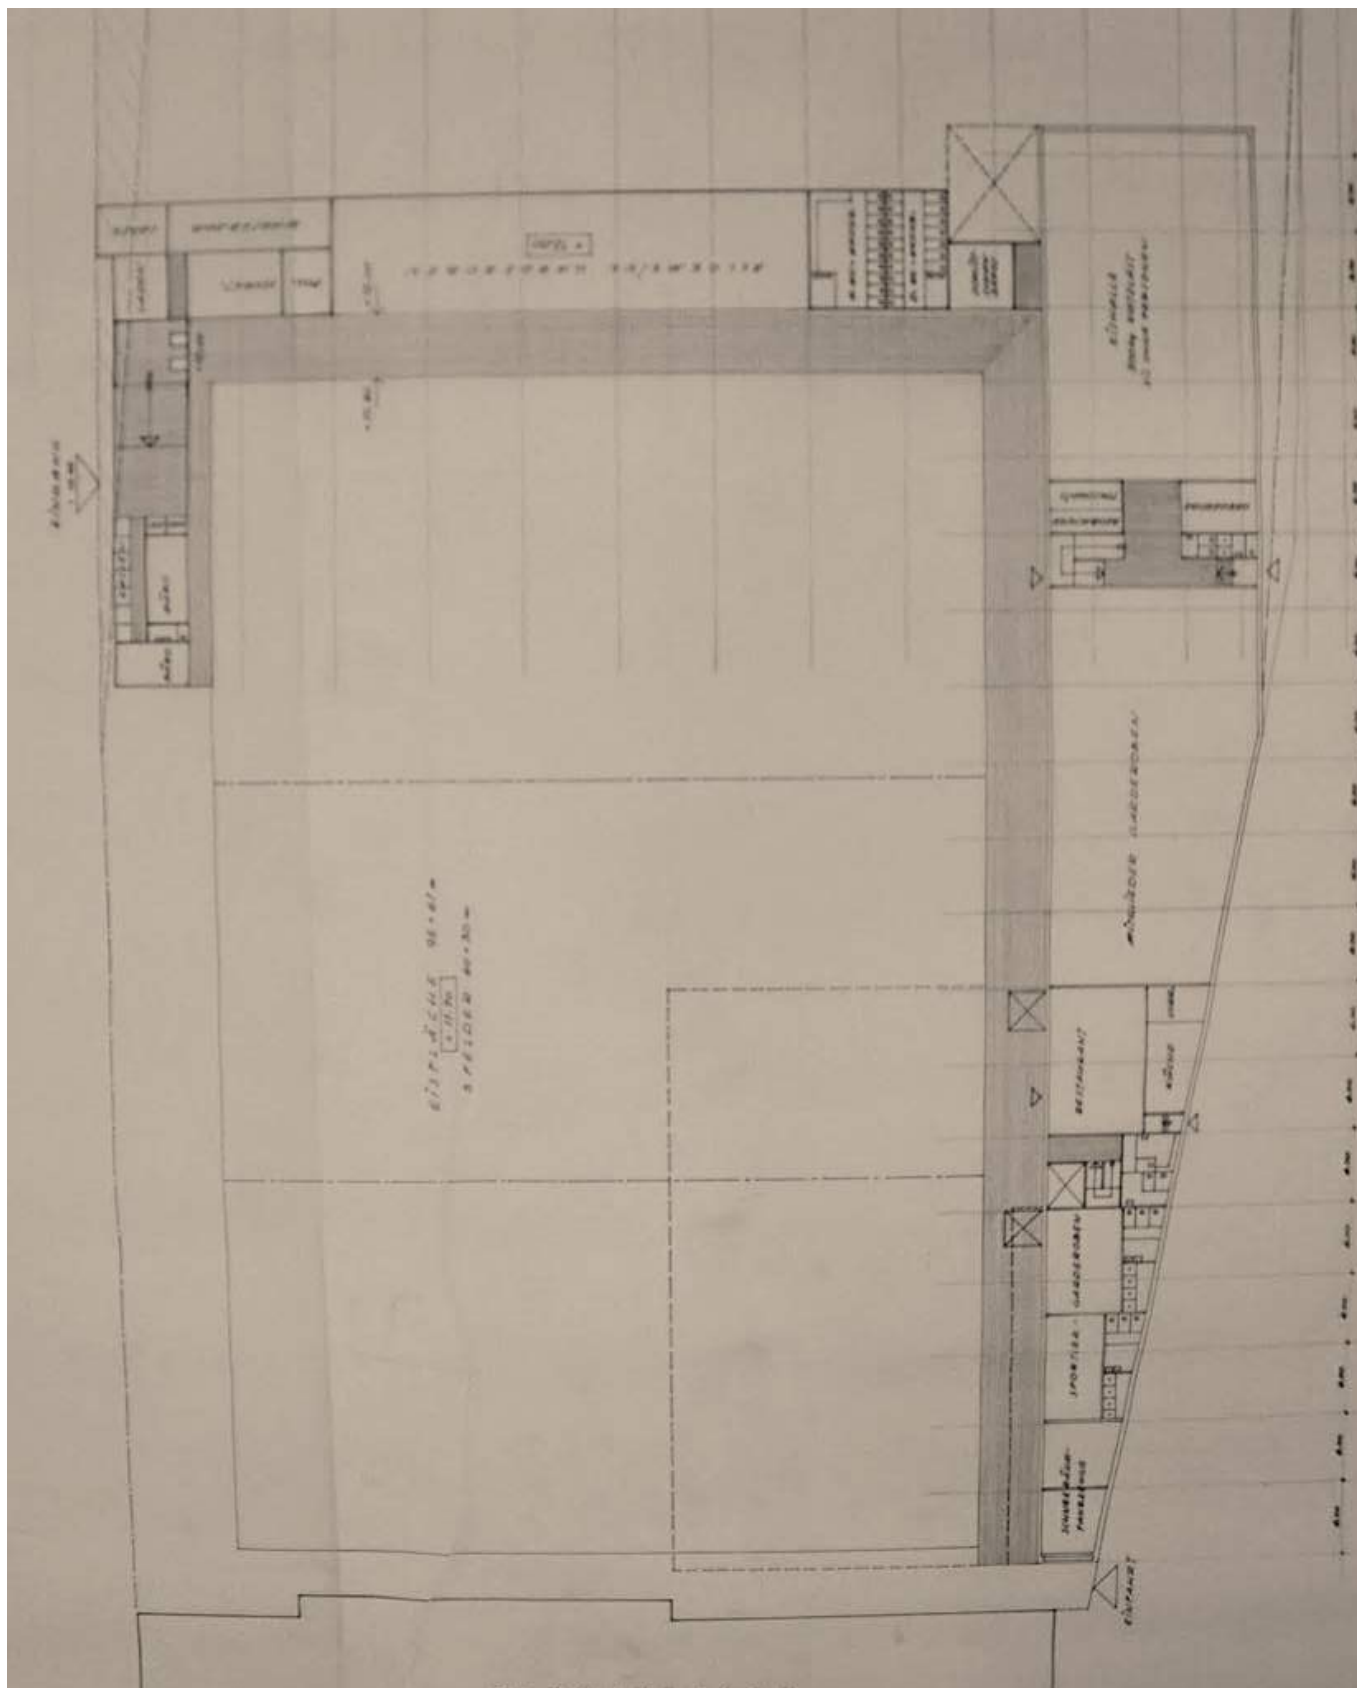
Wien, Entwurf Erdgeschoss Eislaufverein, Carl Appel und Walter Jaksch, 1959
